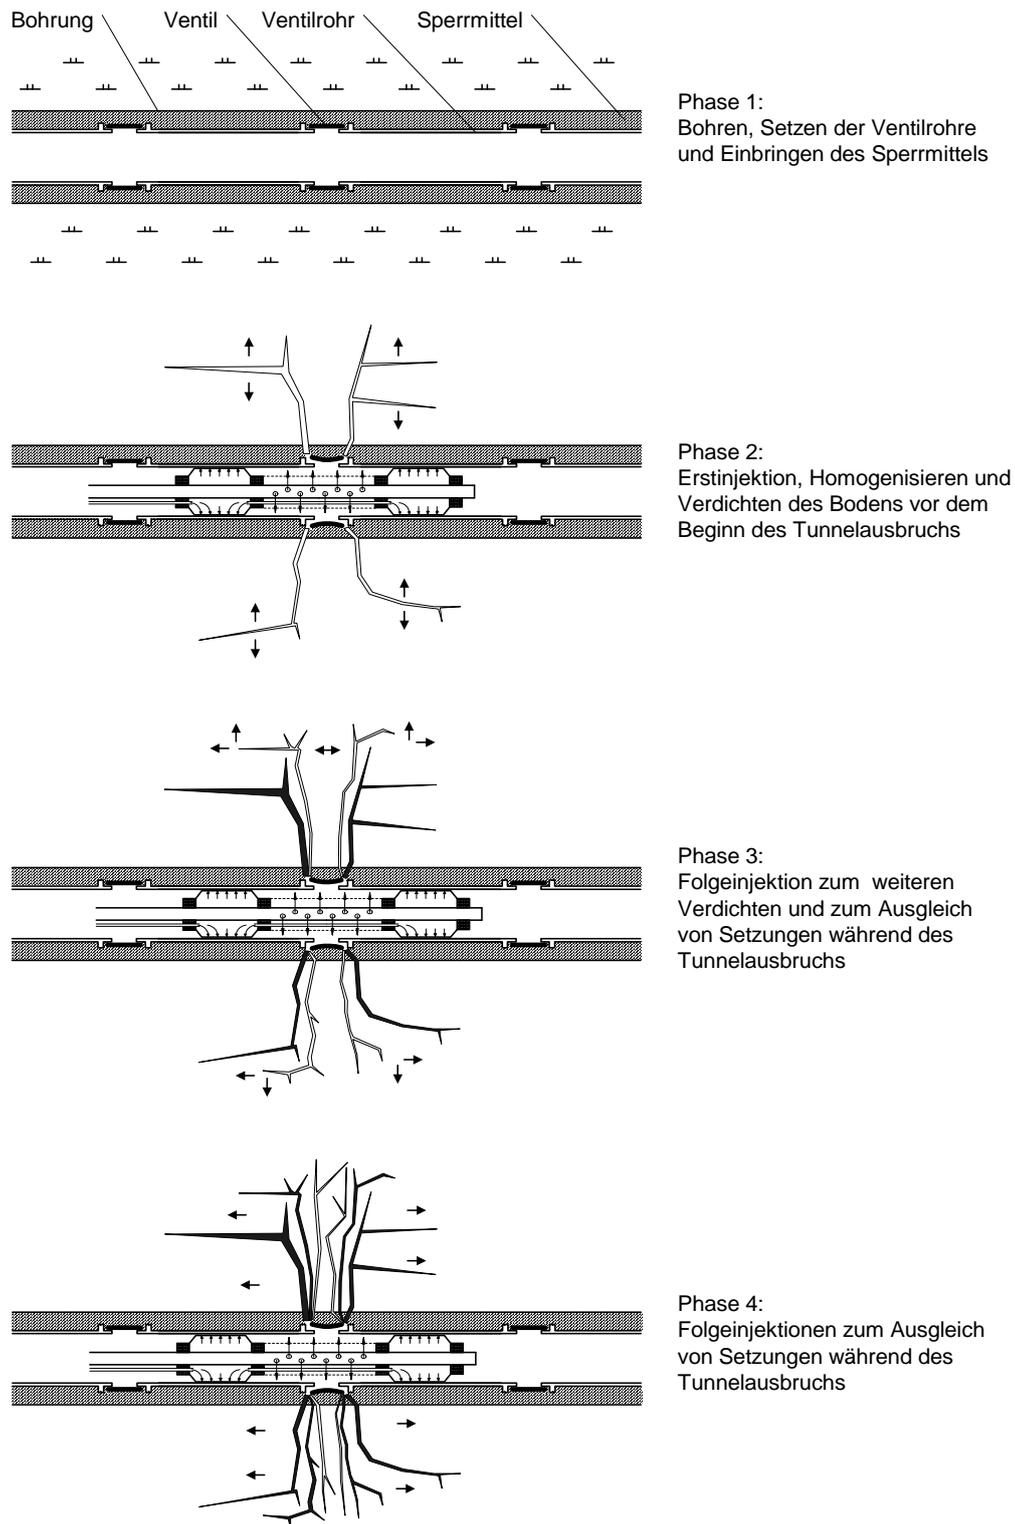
Verpressvorgänge zur Injektionsstabilisierung
